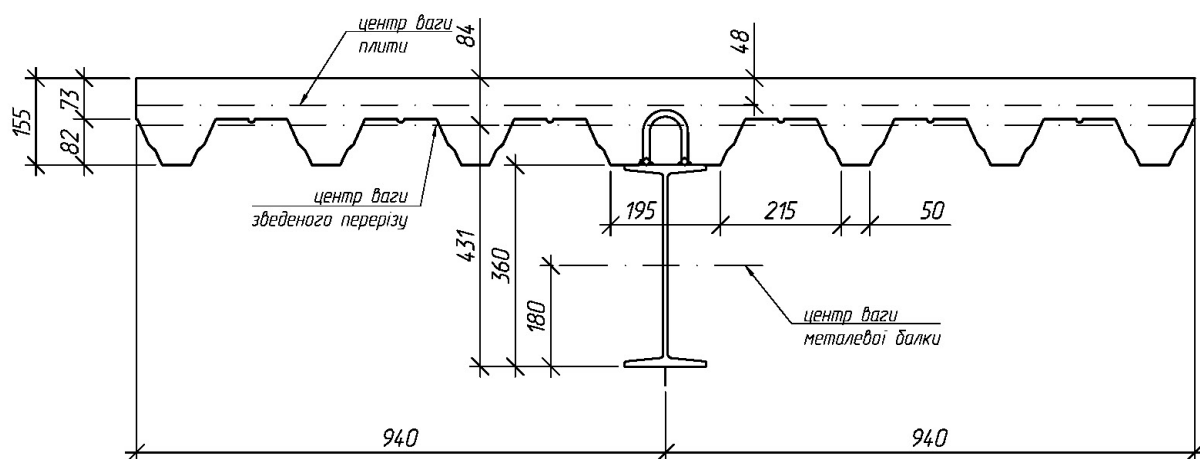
Сталезалізобетонний верхній пояс шпренгельної конструкції.
